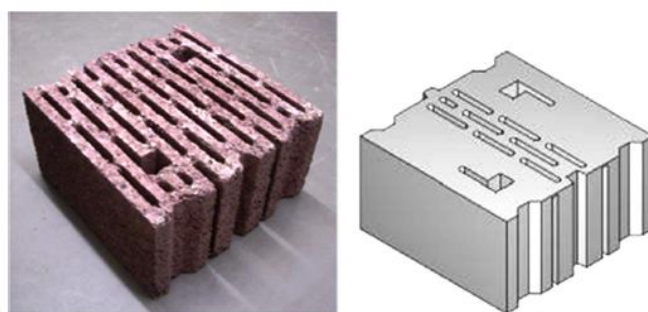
Configuração do bloco de betão leve proposto por Sousa *et al.* (2014) [27]
